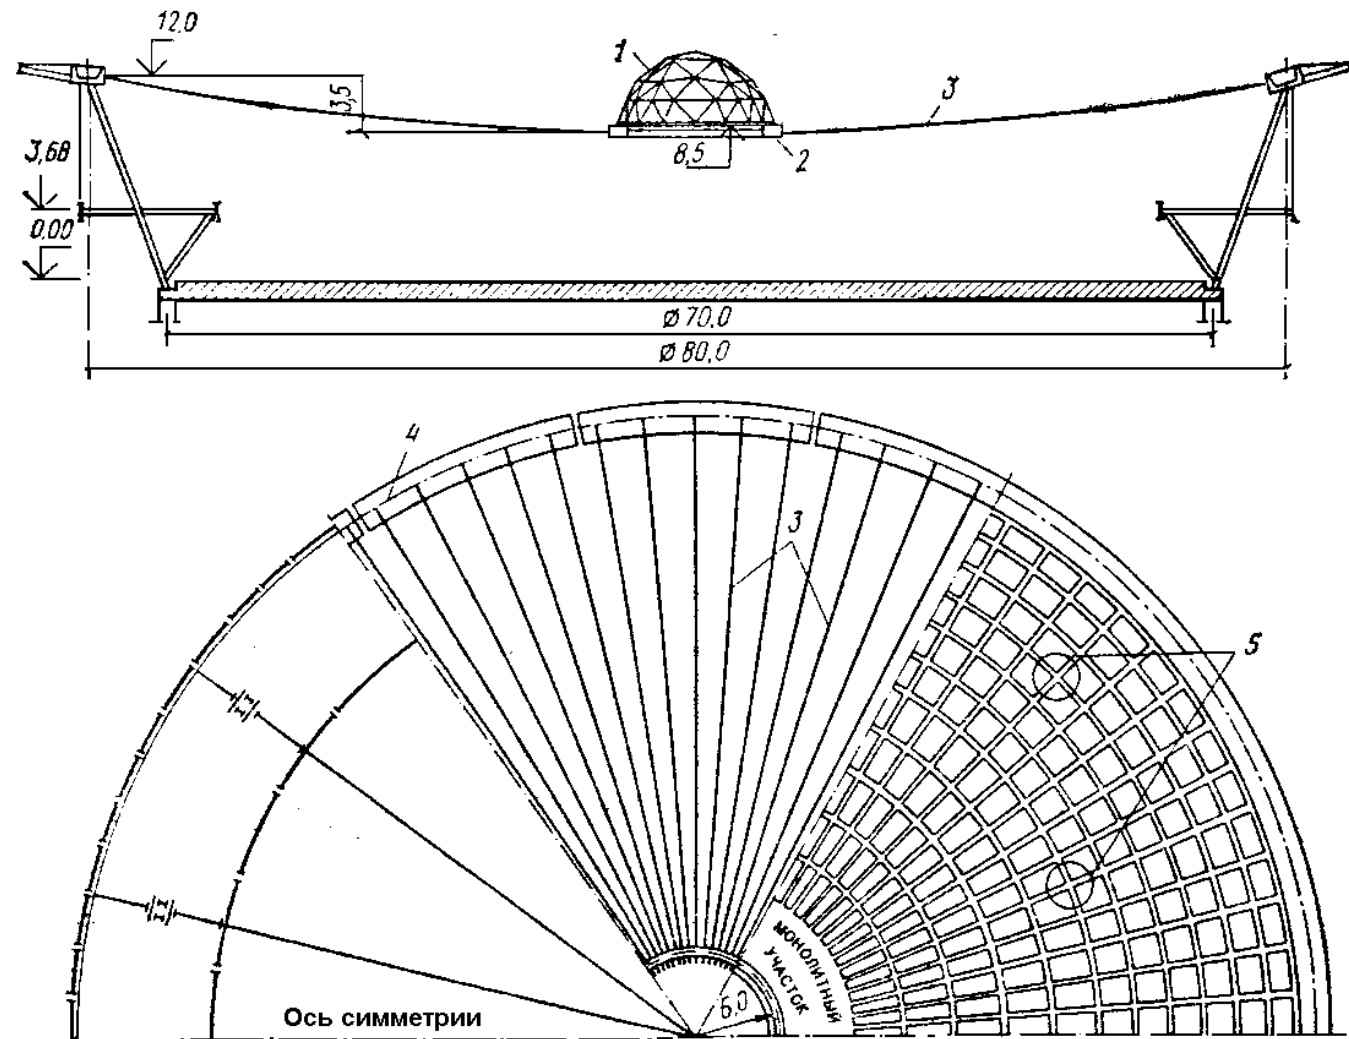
Вогнутое висячее покрытие на круглом плане[13].
